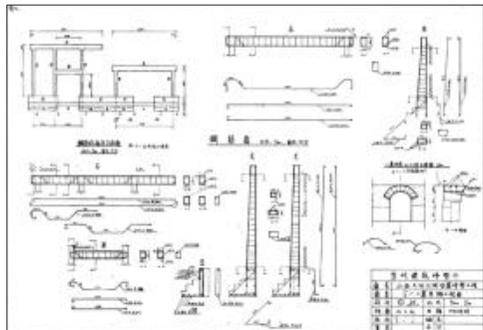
第 1、2 窟钢筋混凝土框架立面图、钢筋图、第 1 窟明窗三心拱大样图
